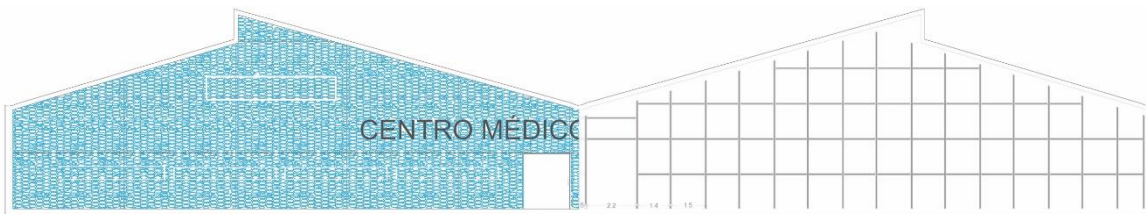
Detalle de estructura y colocación de paneles prefabricados de aluminio.
